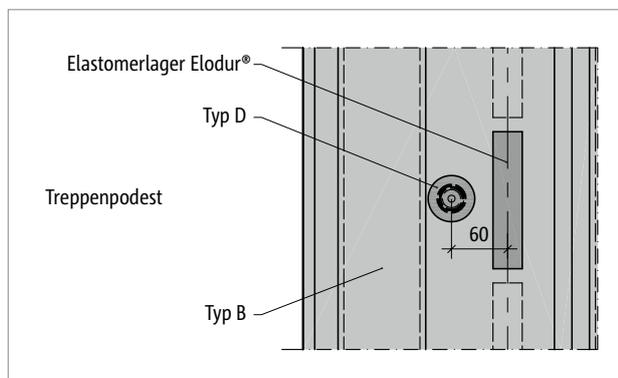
Schöck Tronsole® Typ B + Typ D: Detail A
